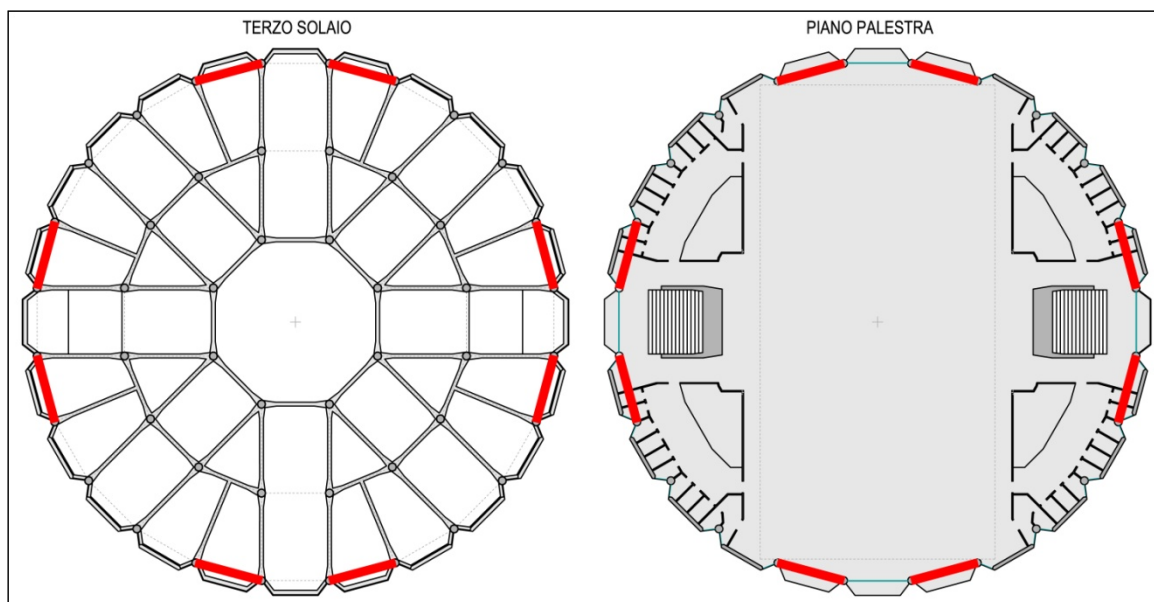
pianta strutturale ed architettonica del terzo solaio con rappresentazione degli interventi
